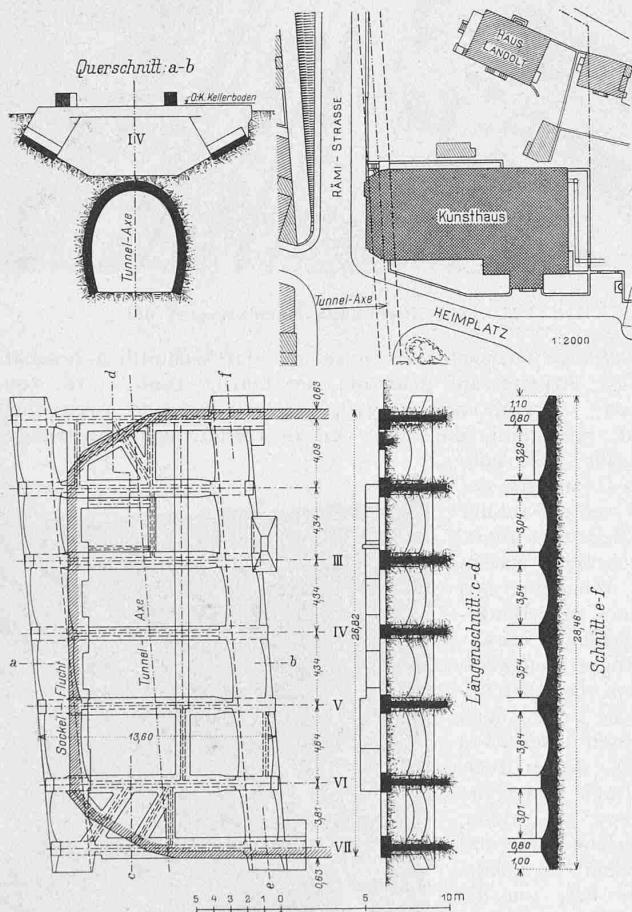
(Rechts oben) Lageplan. — Masstab 1:2000.
